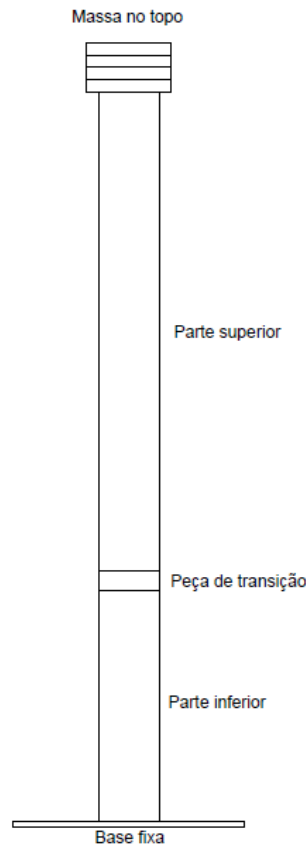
Corte longitudinal esquemático do monopilar.
